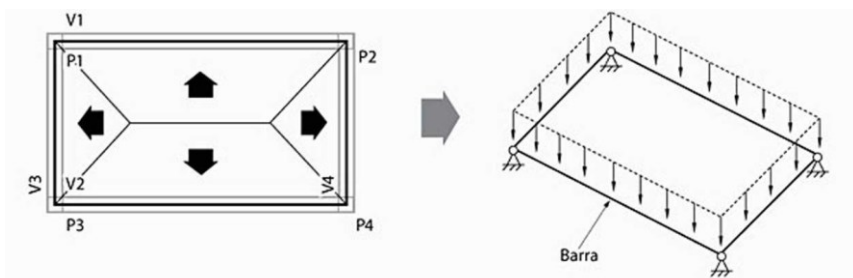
Grelha sem vigas (KIMURA, 2007)
